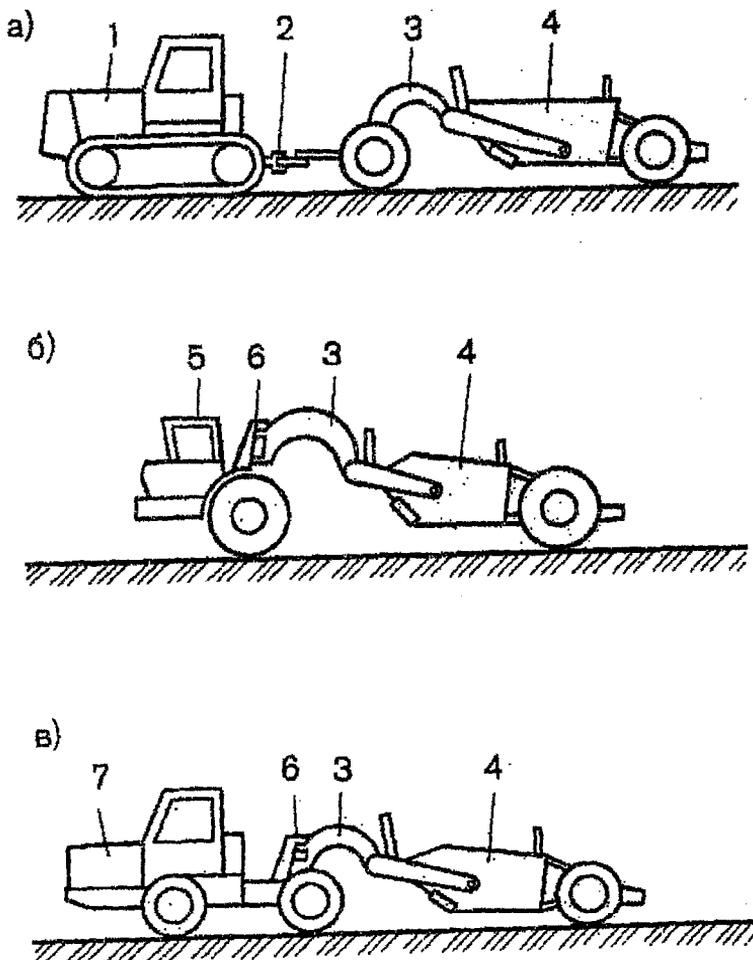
Скреперы : а – прицепной : б, в – самоходный двух и трёхосный; 1, 7 – гусеничный и колёсный трактора : сцепное и седельно – сцепное устройство : 3 – рама; 4 – ковш; 5 – одноосный тягач.
